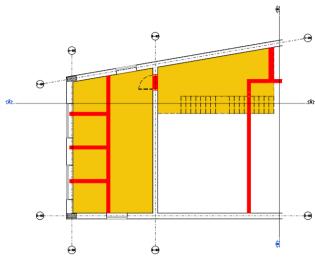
Pianta Piano Intermedio - stato di raffronto
